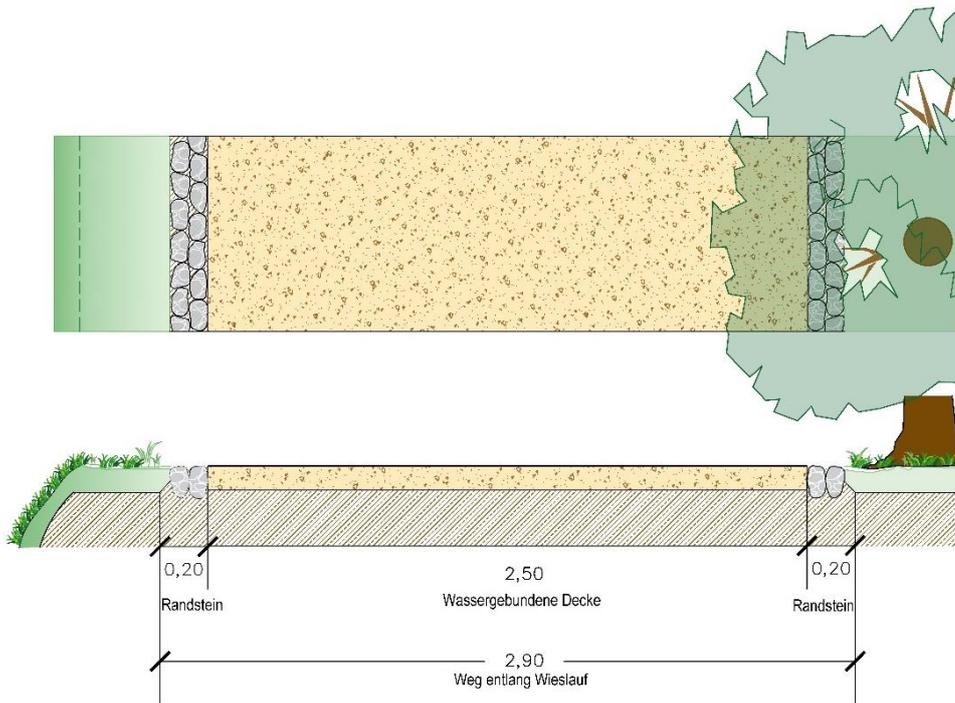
Beispielschnitt/ -draufsicht Wieslaufweg, Abschnitt Rathausplatz mit wassergebundener Decke
